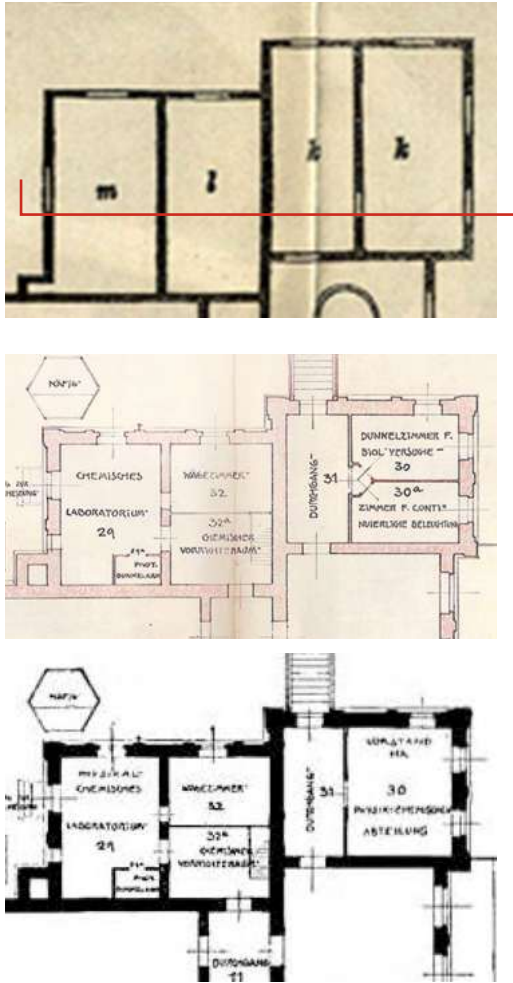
Rekonstruktionsgrundlagen Ostpavillon:
